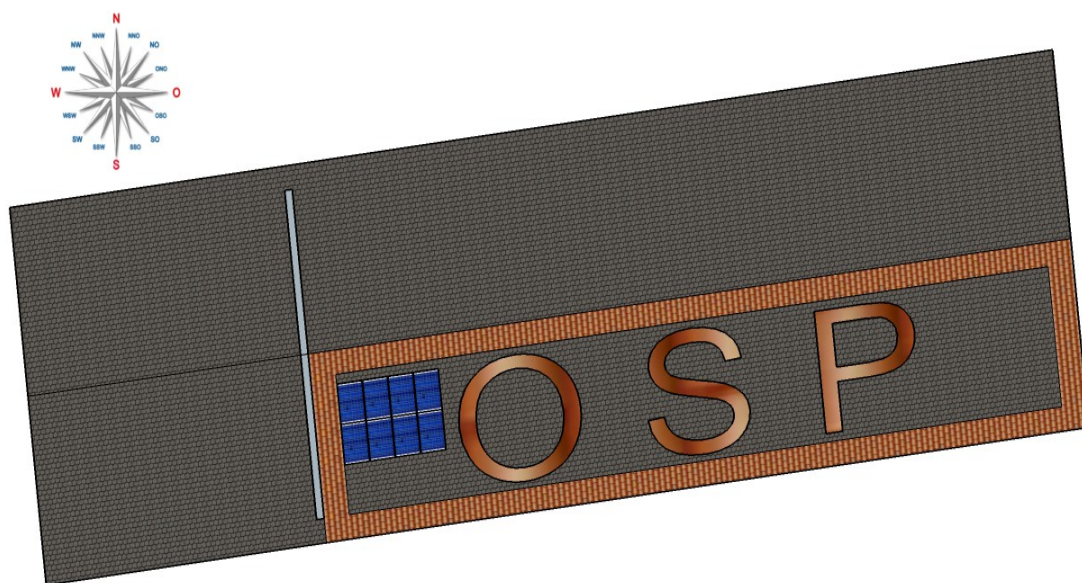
Stan obecny pokrycia dachowego – wymiary dachu
